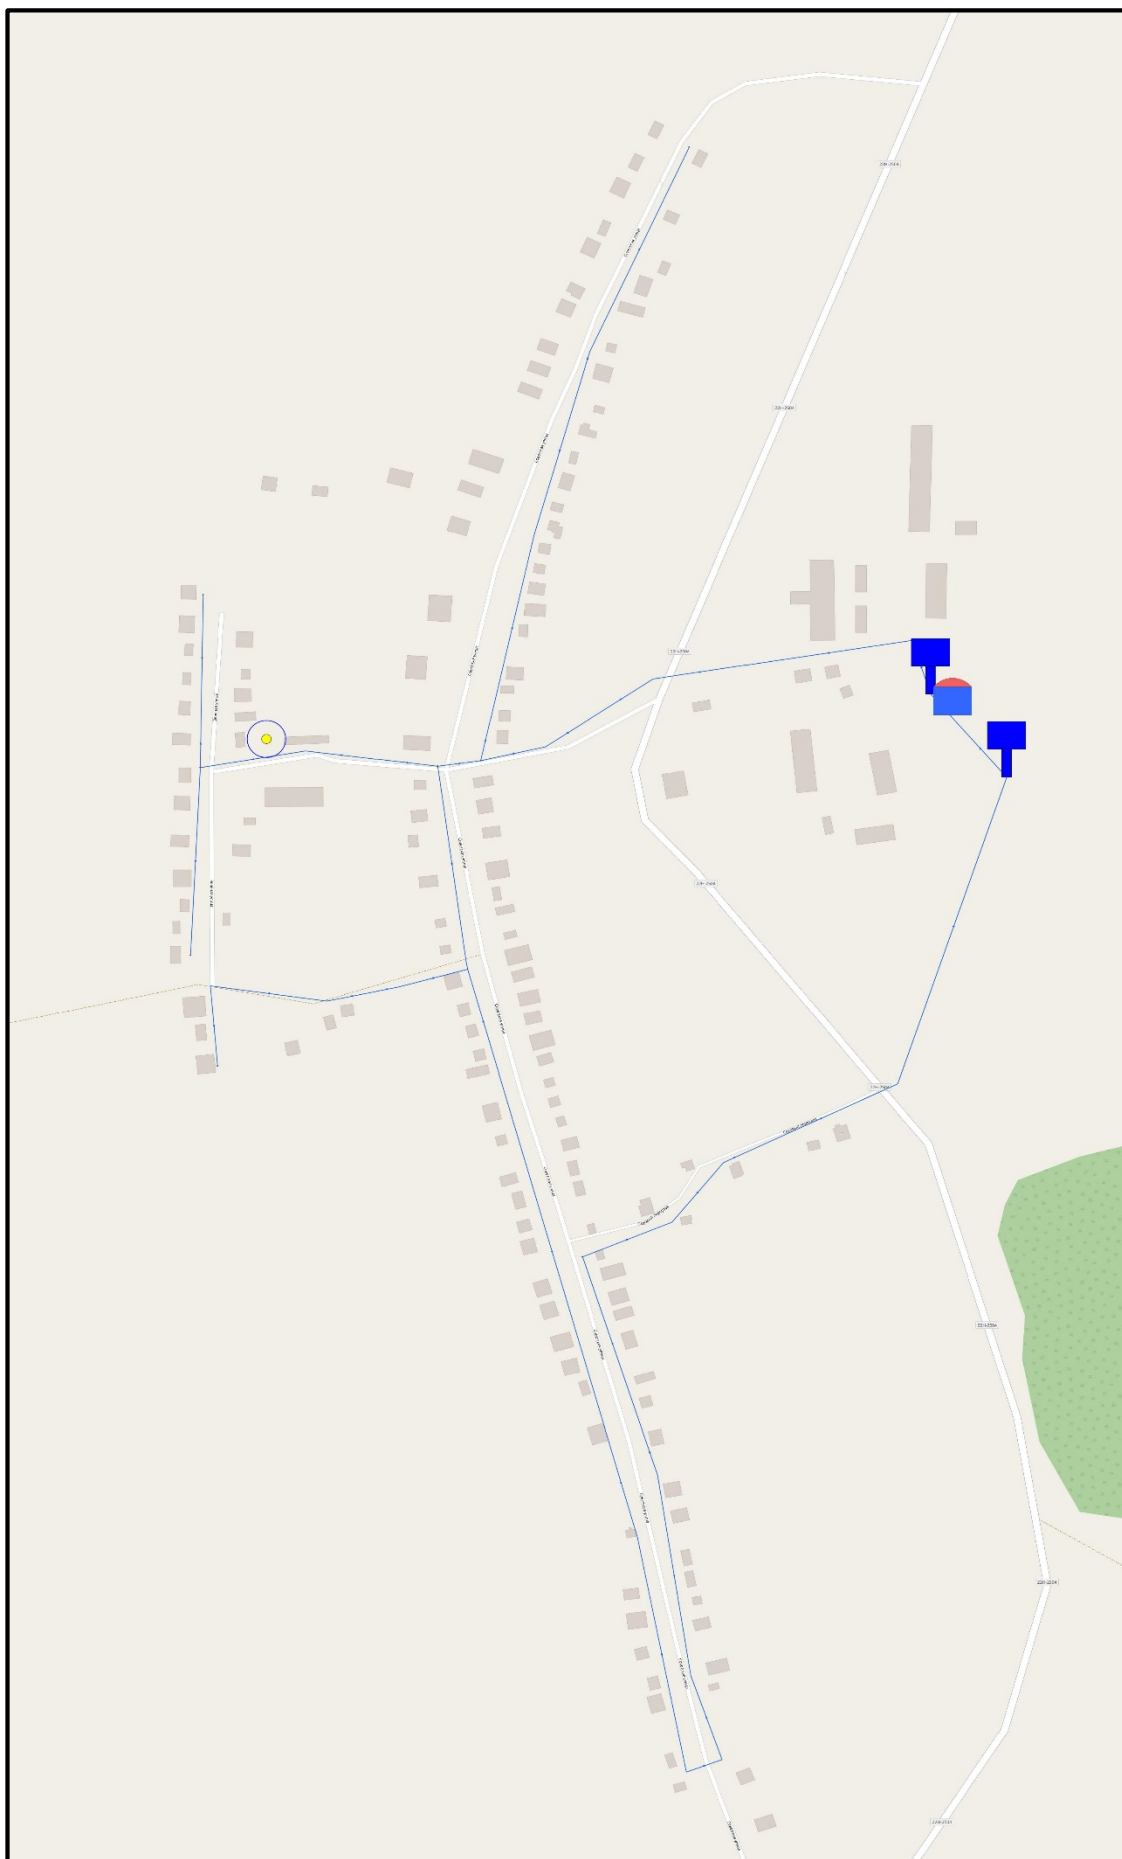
Схема водоснабжения с. Кечасово
